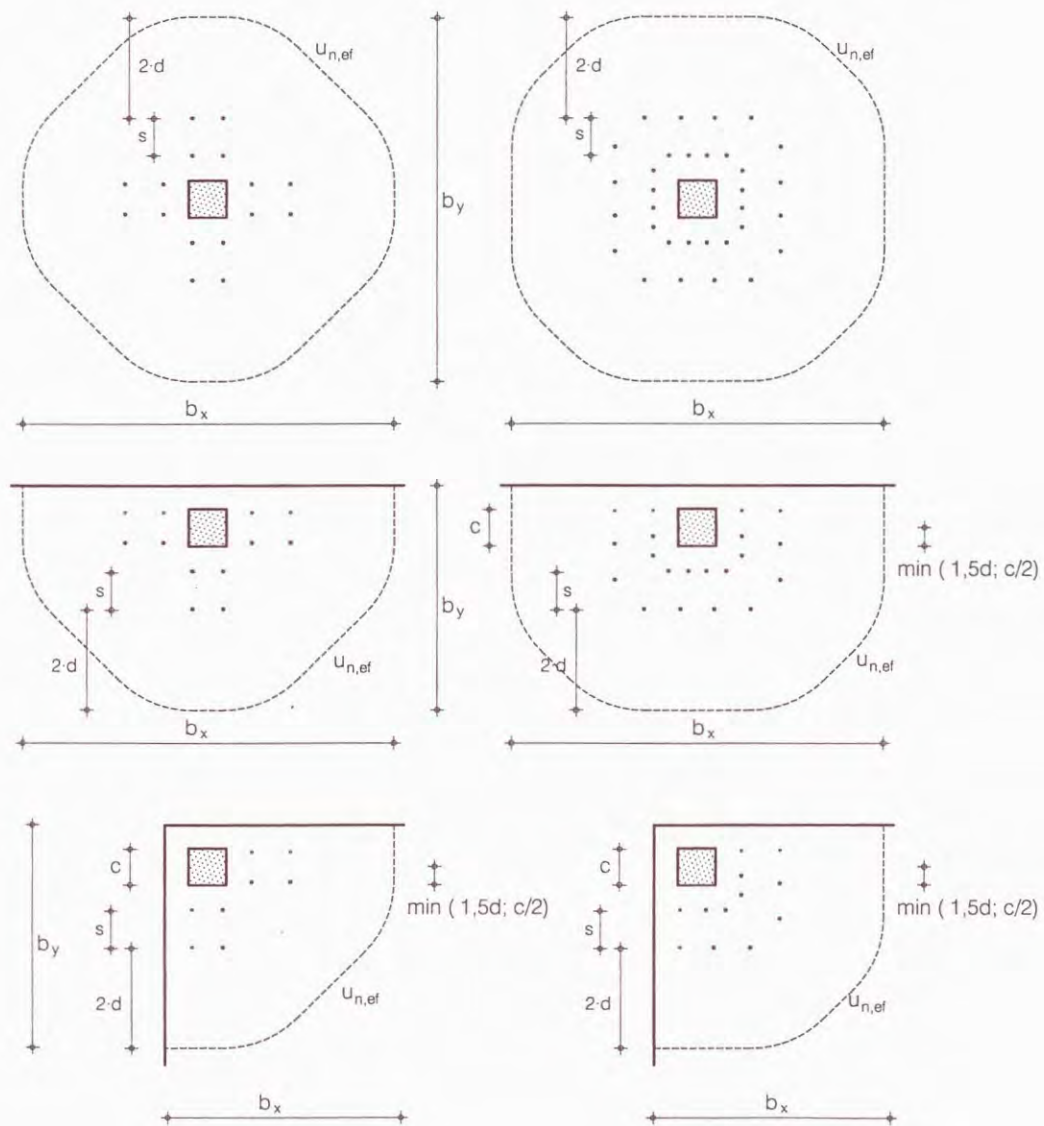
a. Armado tipo a punzonamiento en planta. En tono más oscuro, armadura calculada. En tono más claro, armadura adicional
